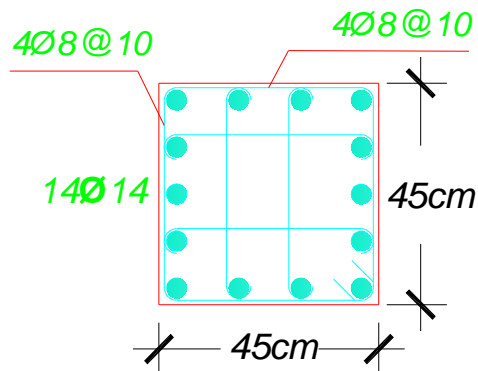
Refuerzo transversal en la conexión viga – columna
